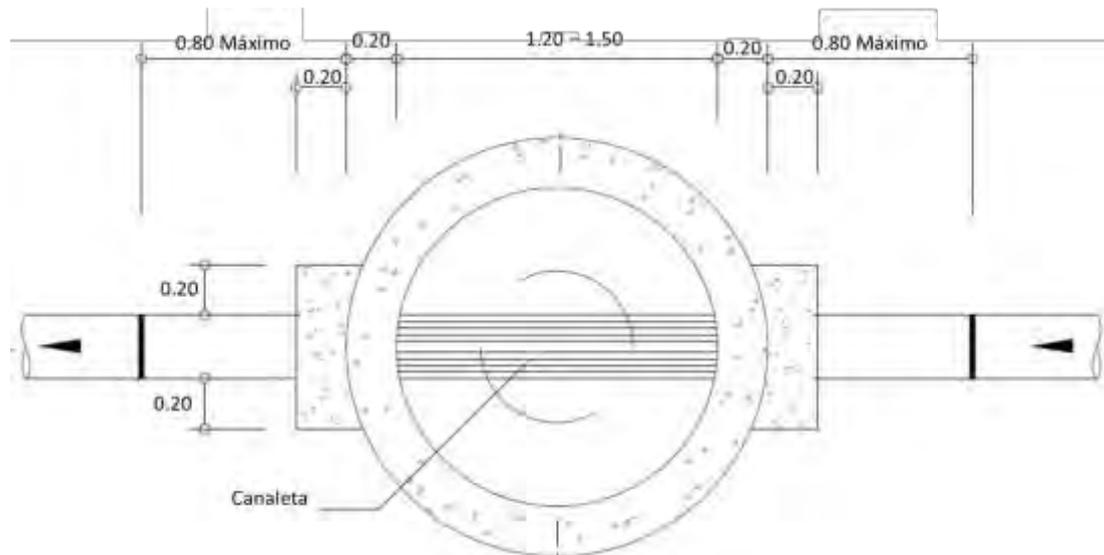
22: Vista superior de buzón de alcantarillado. Medidas en metros [38]
